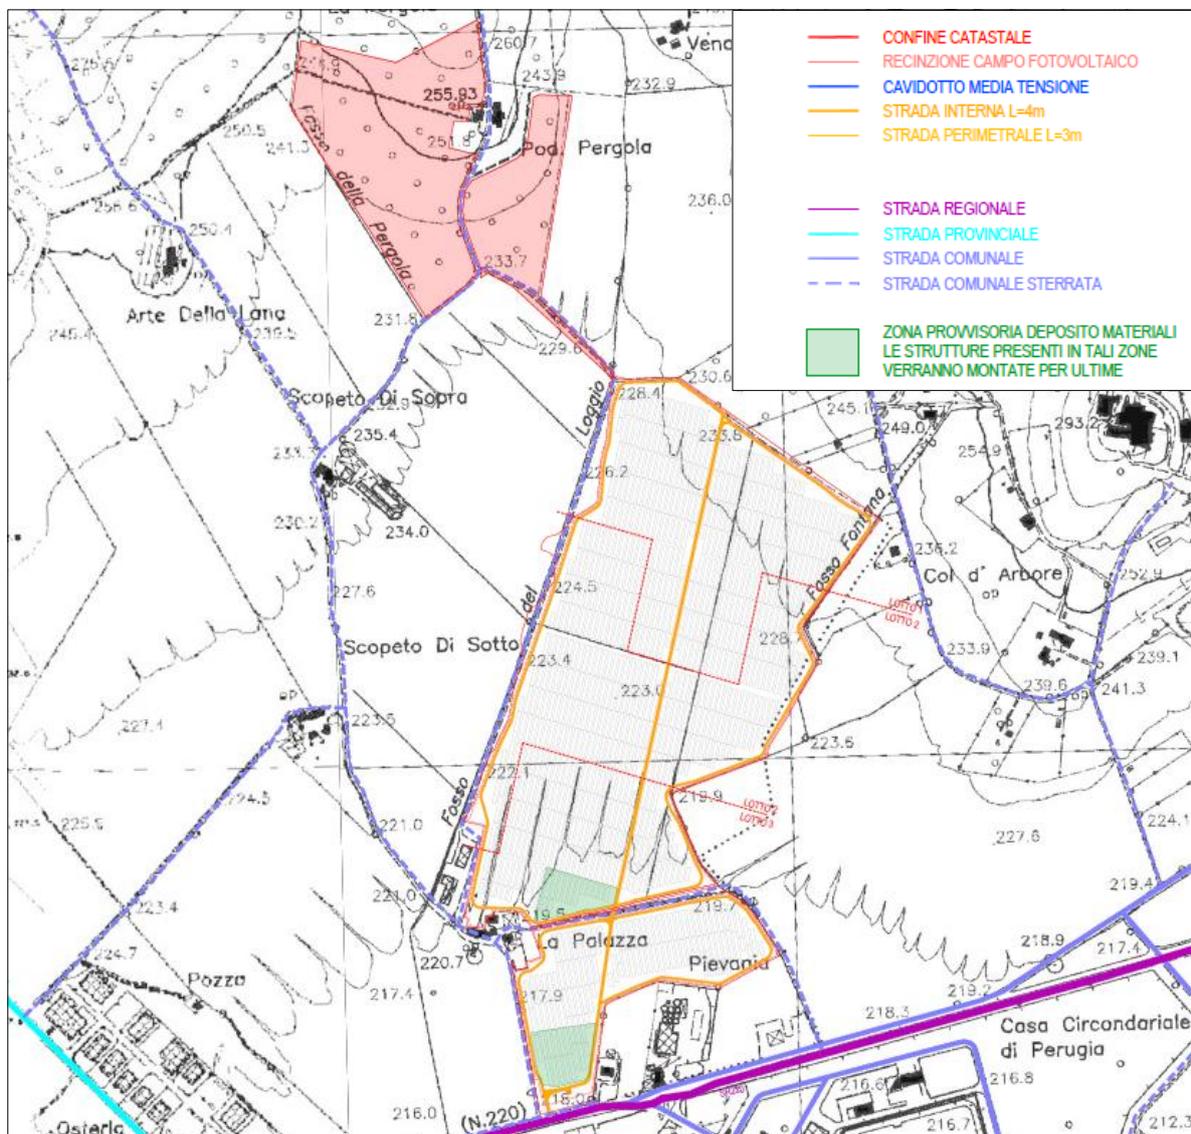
Ubicazione aree di cantiere dell'impianto
